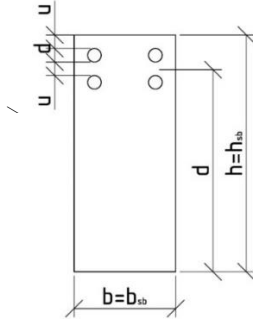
Розрахунковий переріз другорядної балки на опорах
